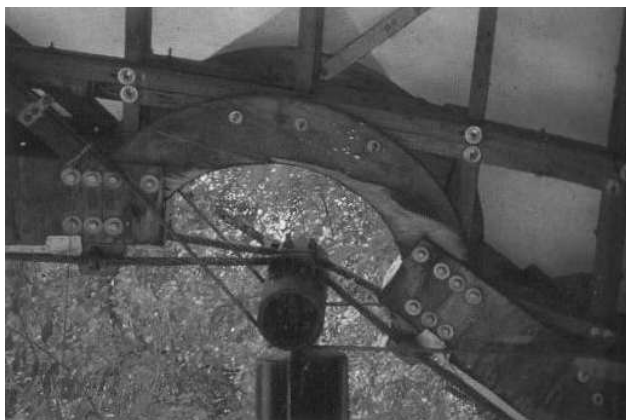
Détail du dispositif de fixation de la grille sur un câble.
